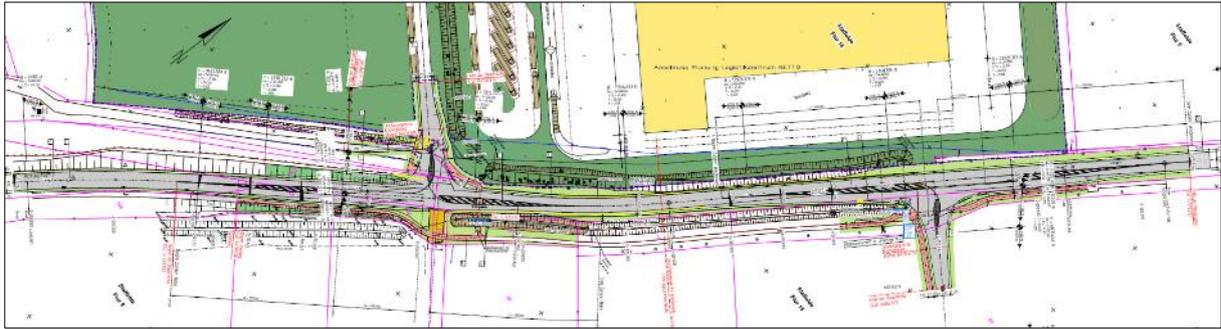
Ausschnitt Lageplan zur Entwurfsplanung, Ingenieurbüro Weiland (Stand 22.11.2022)
